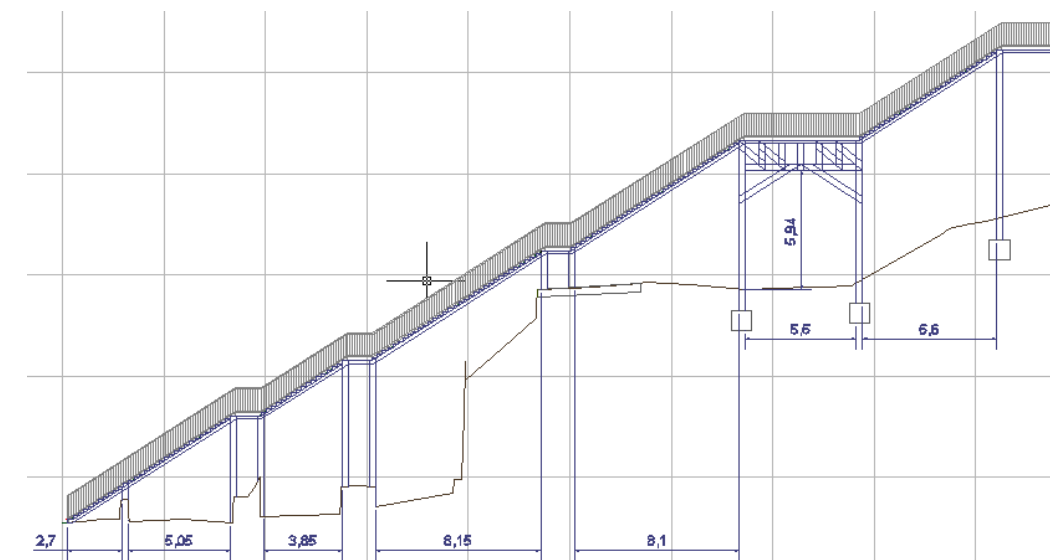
C3 –Perfil longitudinal de la estructura proyectada.
